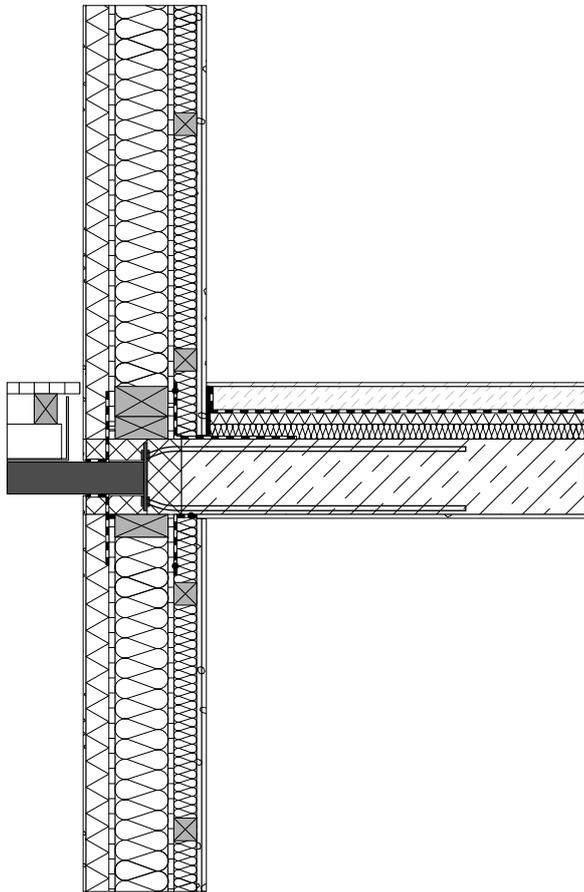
Balkonanschluss mit Außenwand WA1-3 - Geschossdecke DE1
